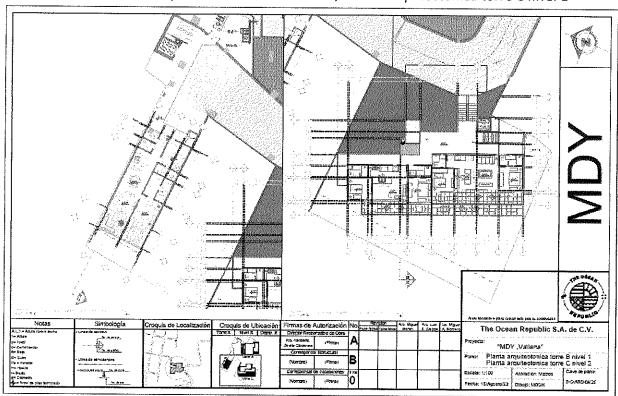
Planta arquitectónica torre B nivel 1, Planta arquitectónica torre C nivel 2
